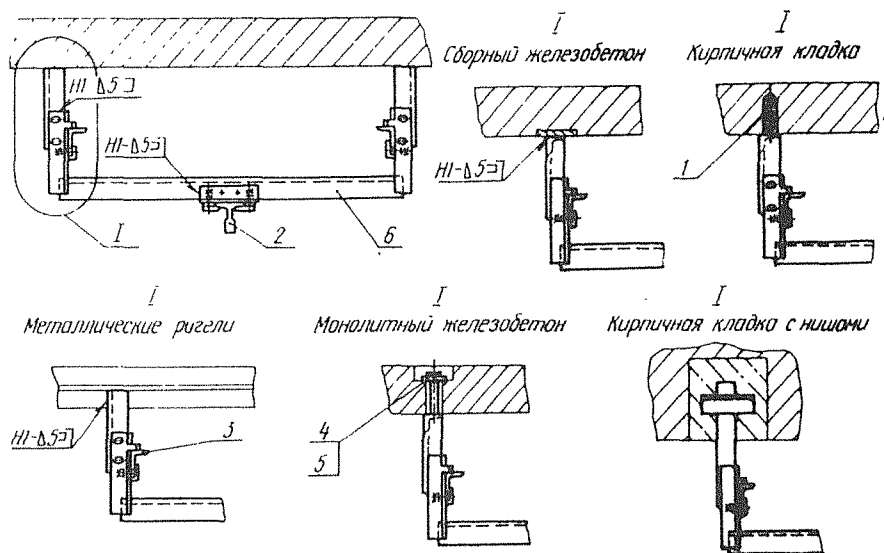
Крепление направляющих кабины и противовеса при боковом его расположении:
